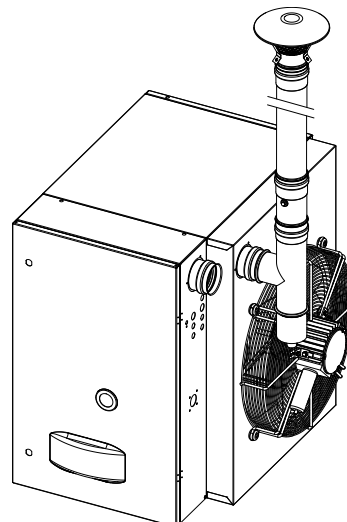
Installazione tipo B22 con tubo fumi a parete
